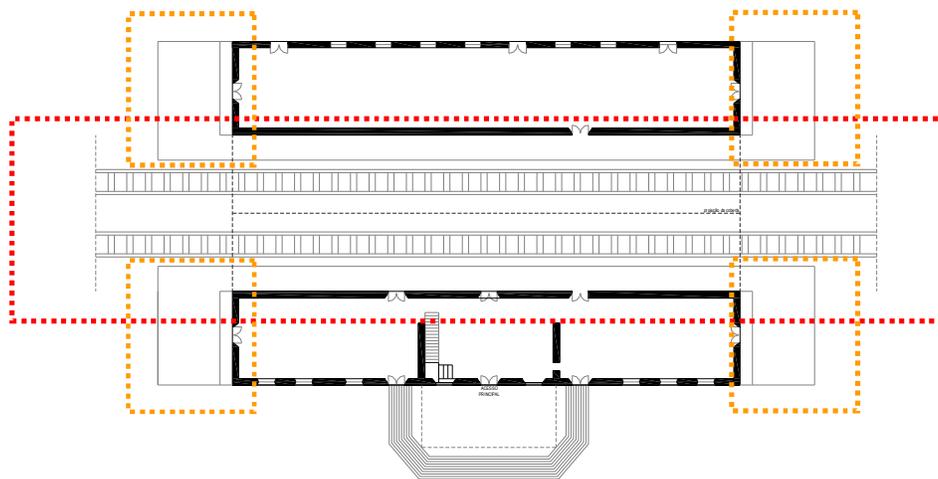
Planta esquemática da antiga estação, mostrando os trilhos dos trens - gare -, bem como a vazadura do módulo central da edificação; ainda, as antigas plataformas externas e internas; sem escala; Fonte: Secretaria de Planejamento de Garanhuns; elaborado por Daniella Esposito, abril 2009
